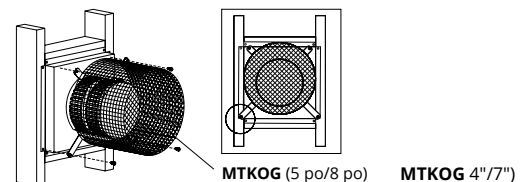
f Installation d'une grille thermique sur un chapeau PTO.
